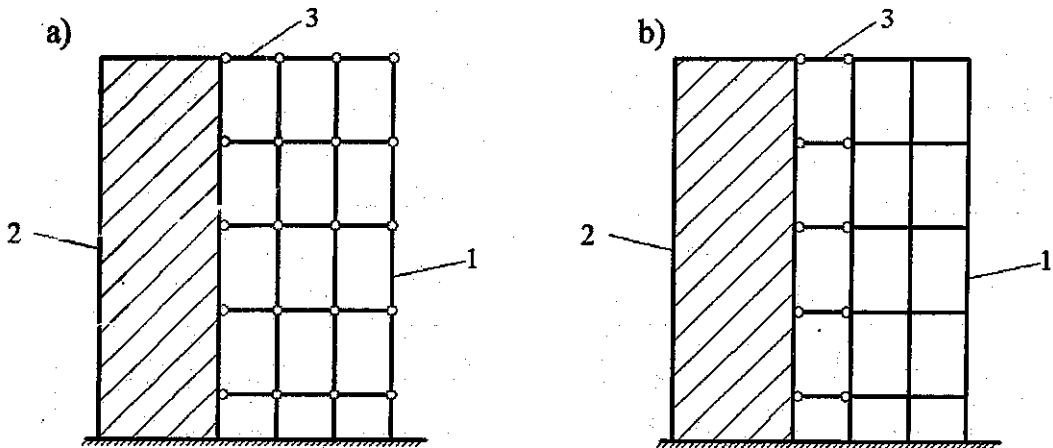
Sơ đồ hệ kết cấu hỗn hợp
